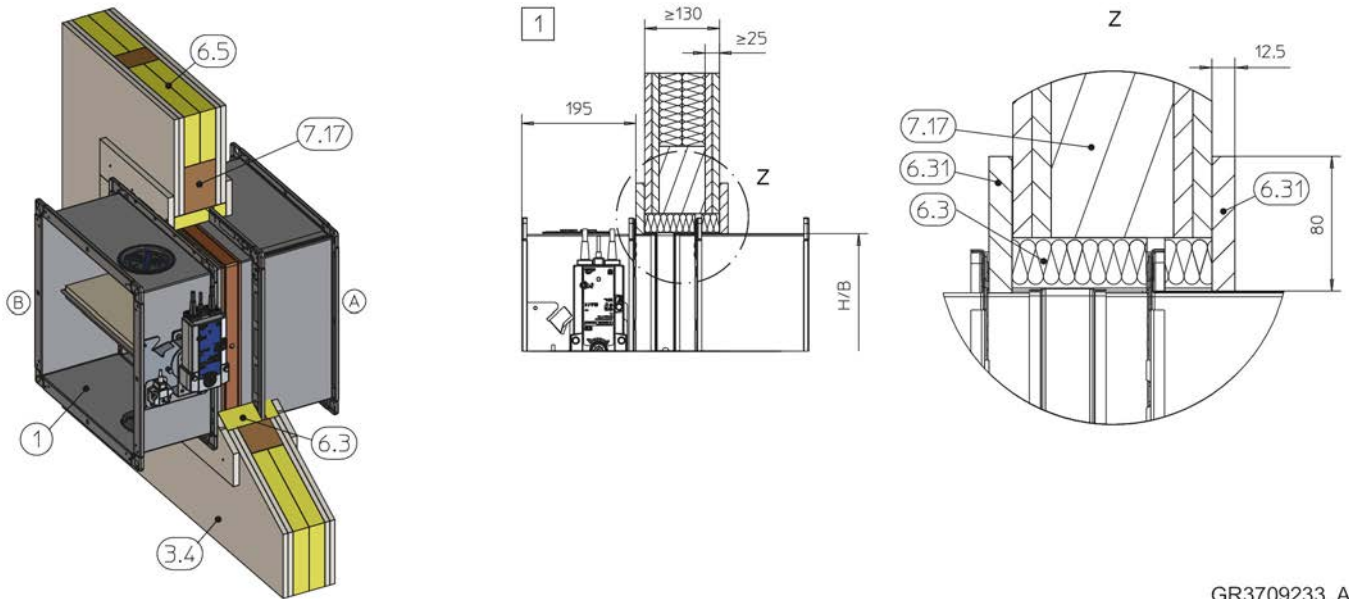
Installazione senza muratura in una costruzione in legno e altro materiale, con kit d'installazione ES
